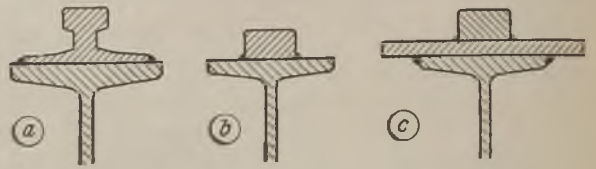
Schweißanschluß von verschiedenen Laufkranschienen.
